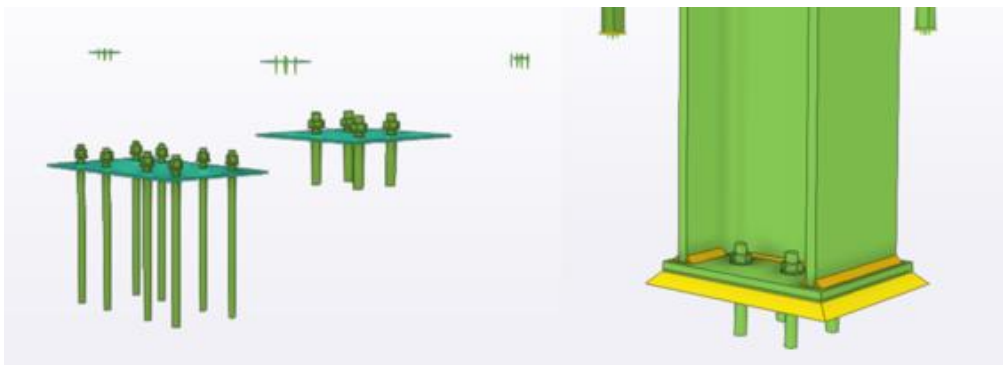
Ligação Coluna - Base Betão (Fonte: Software Tekla, 2023)
